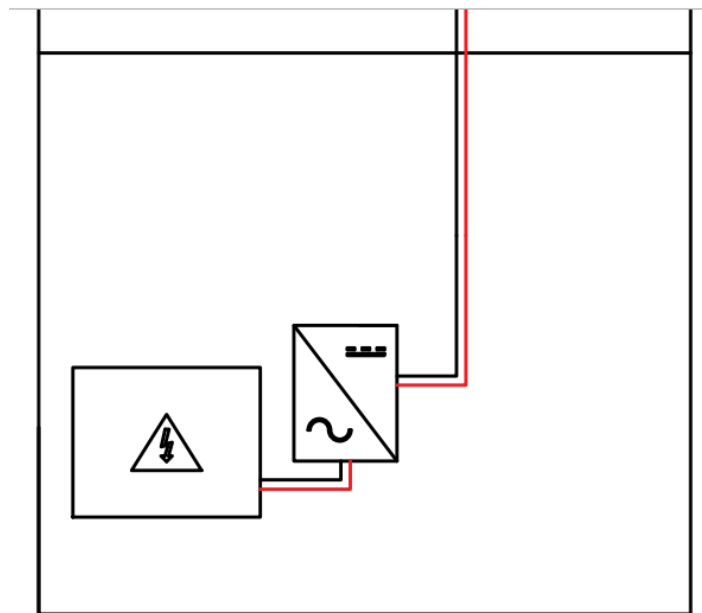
Inversor y cableado al cuadro eléctrico en la planta baja.
